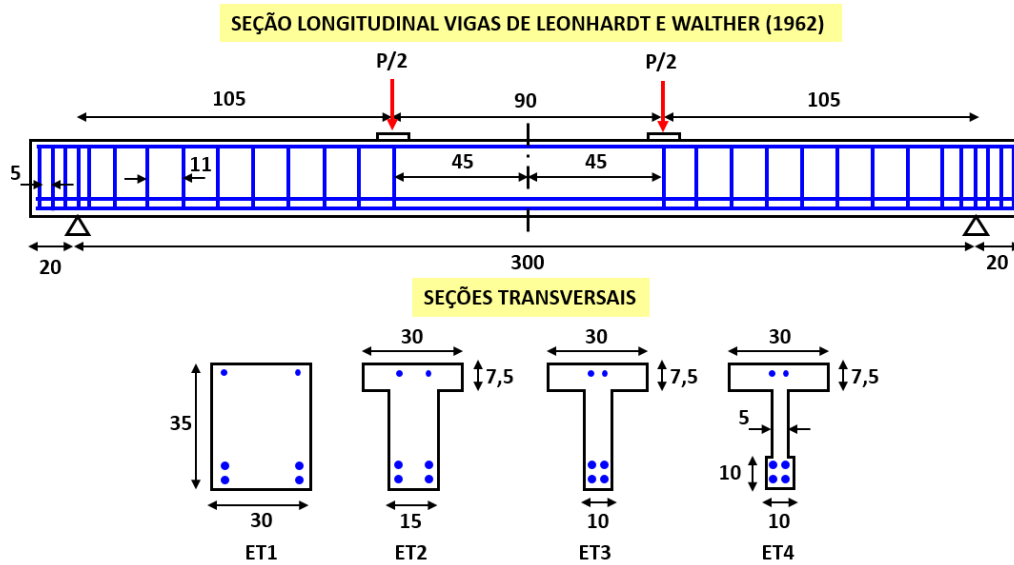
Esquema das seções longitudinal e transversal das vigas de Leonhardt e Walther (1962) (cotas e medidas em centímetros)
